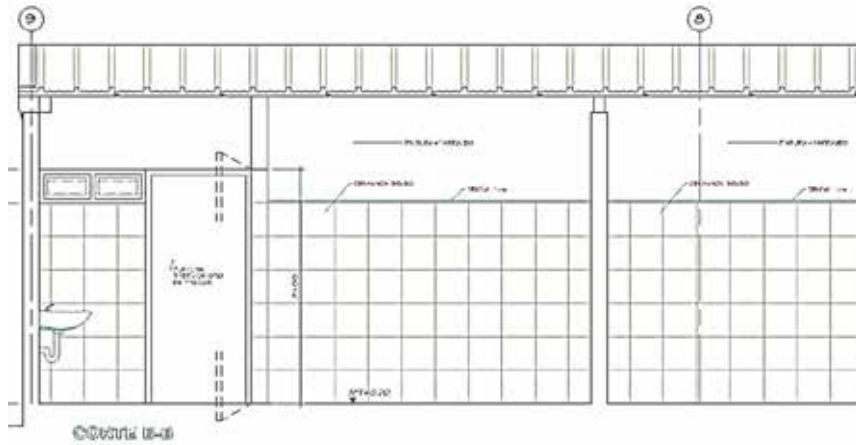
Detalle interno de sala sanitaria, Planta Procesadora de Pescado. (2016)
